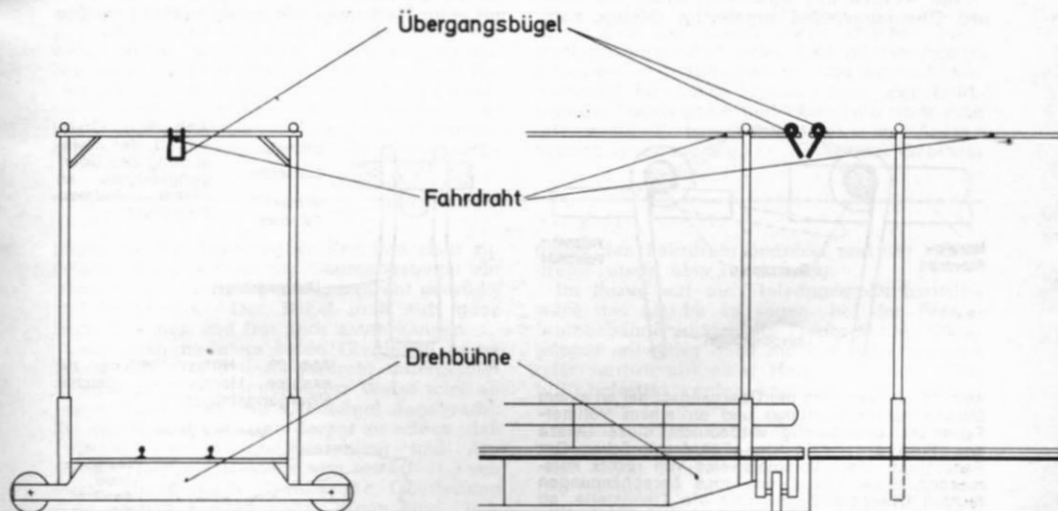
Unmaßstäbliches Konstruktionsprinzip der Fahrdrahtbrücke des Herrn Bartmann; links die Front- und rechts die Seitenansicht (Details Abb. 27–29).
